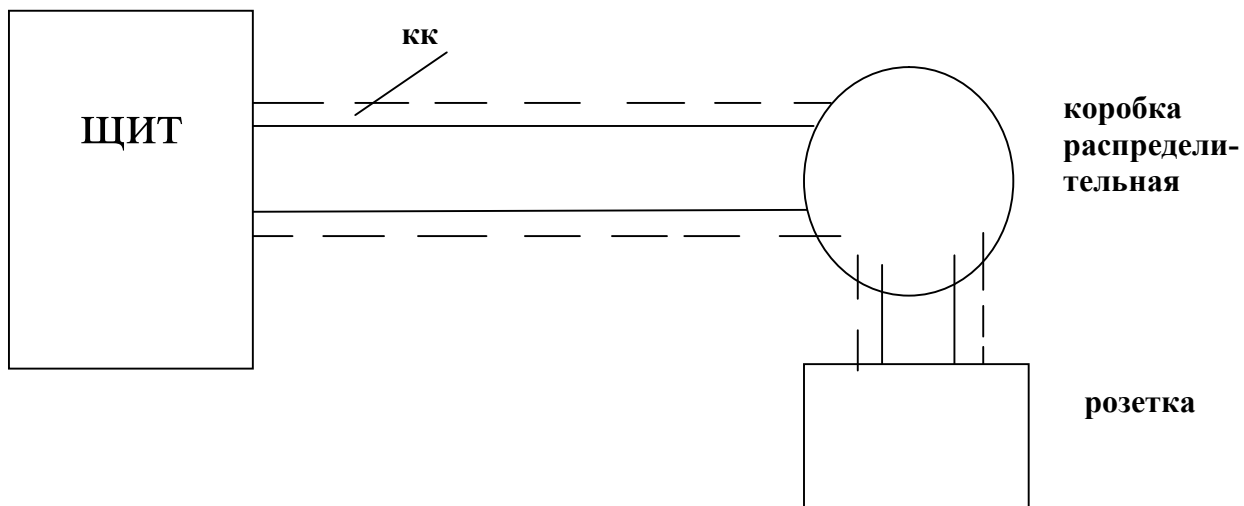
Схема монтажа внутренней электропроводки с розеткой
